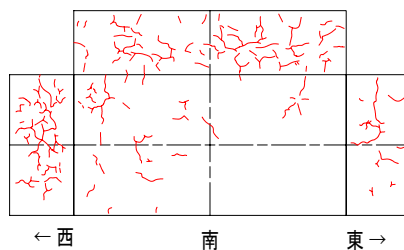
model-b(配合 No. 1)のひび割れ状況
